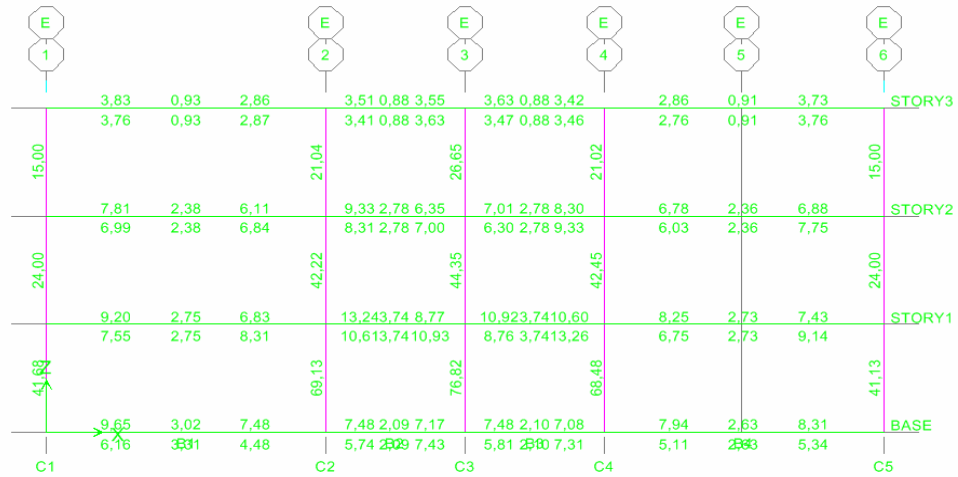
K2 kirişi betonarme analiz bilgileri
